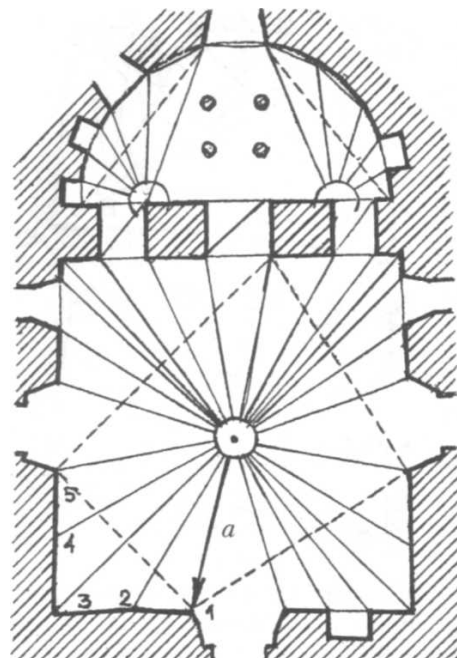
Обмер планов двух смежных помещений, связанных между собой узким проходом
